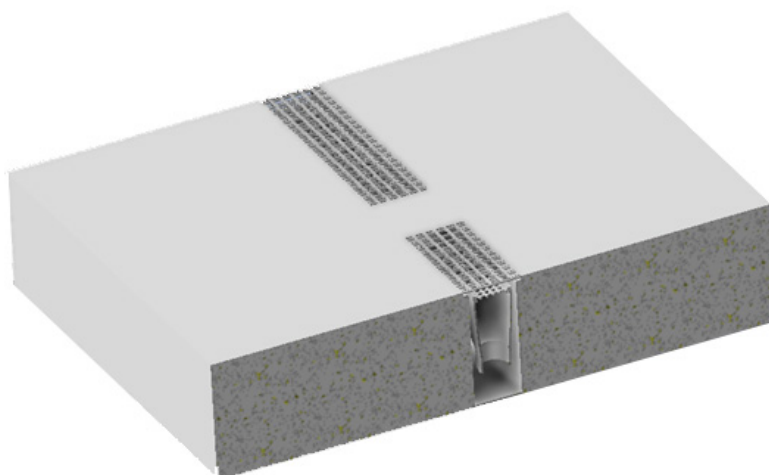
Sezione assonometrica frontale bocchetta, griglie, cavedio e terrapieno.
